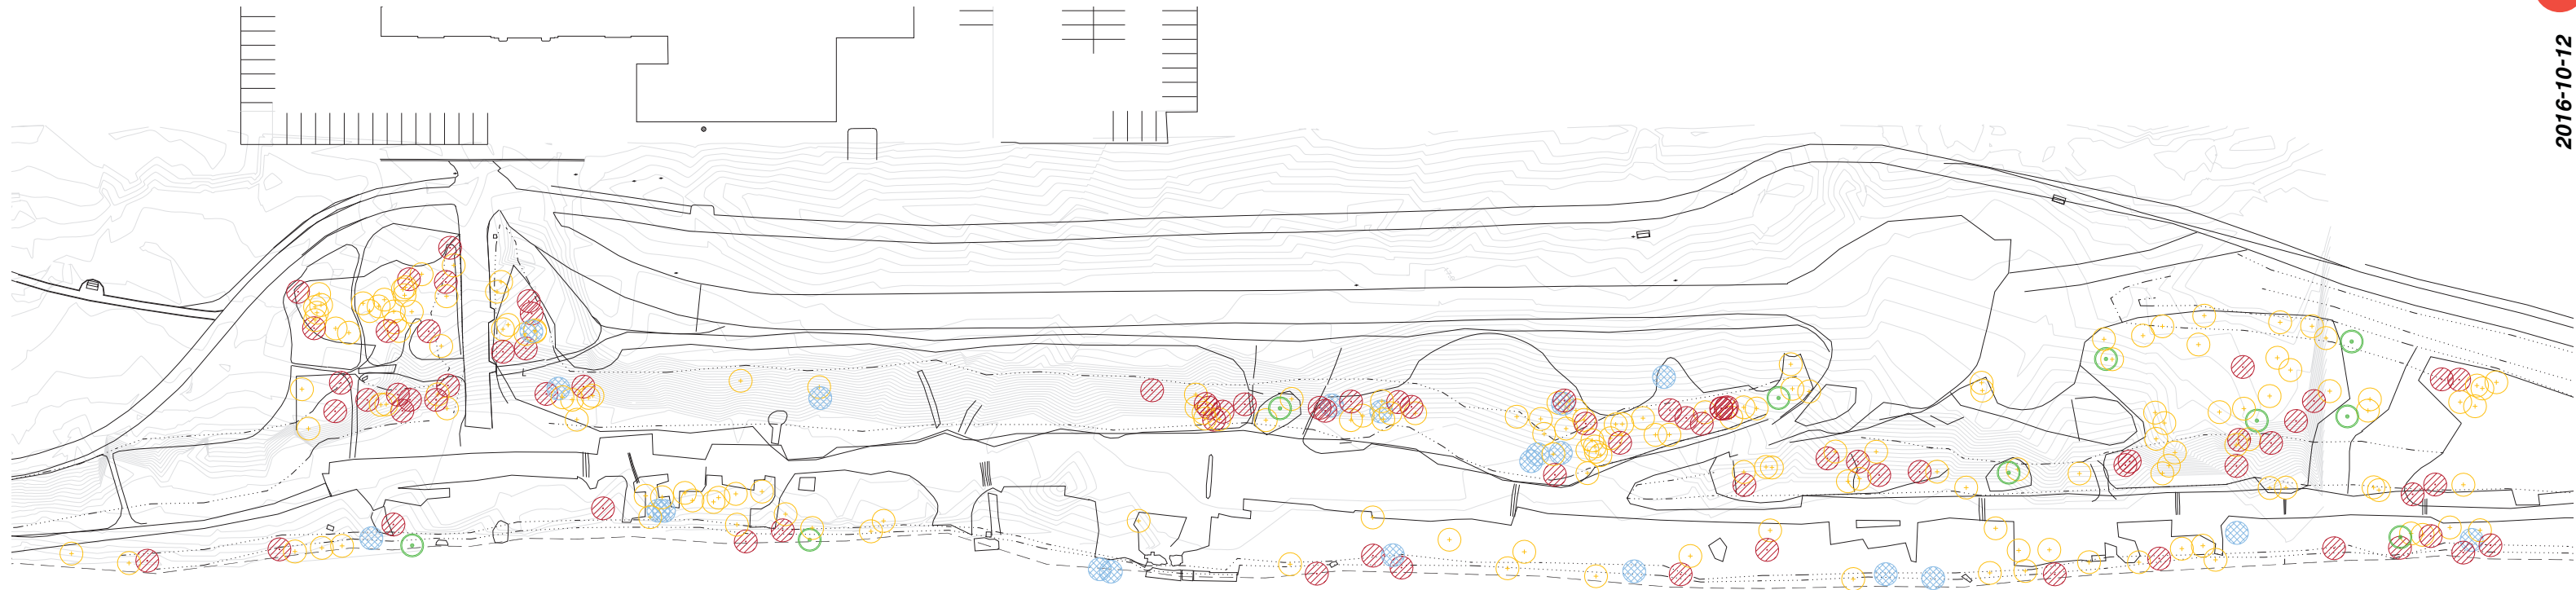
Plan des arbres existants - Arrondissement de Verdun
